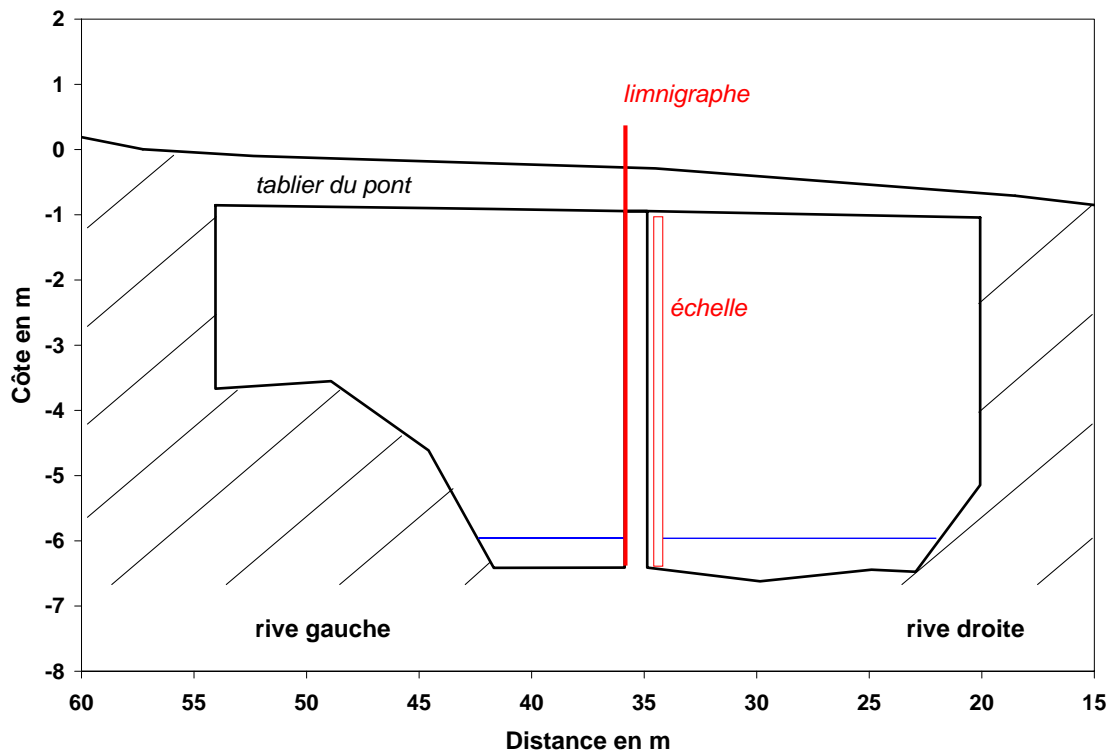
Station de mesure de Saint Hilaire sur le Lauquet - schéma de la section
